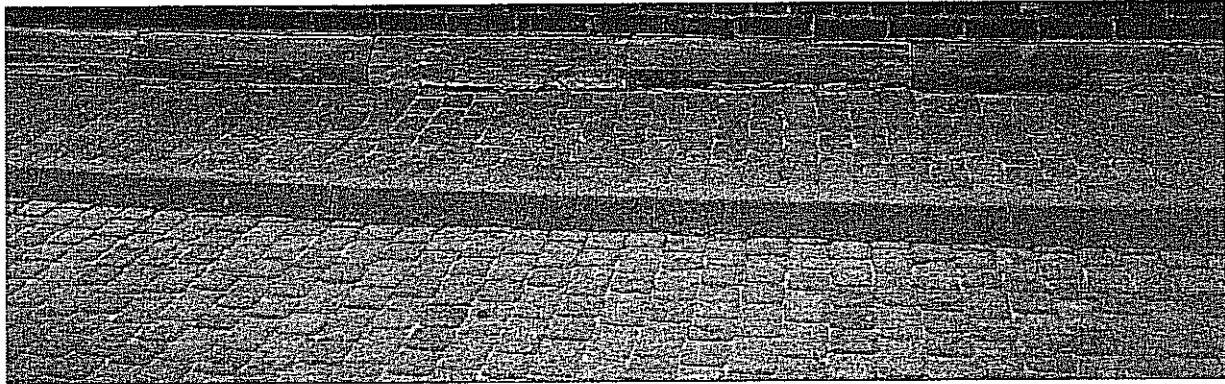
Zapadnięcie części elementów nawierzchni
